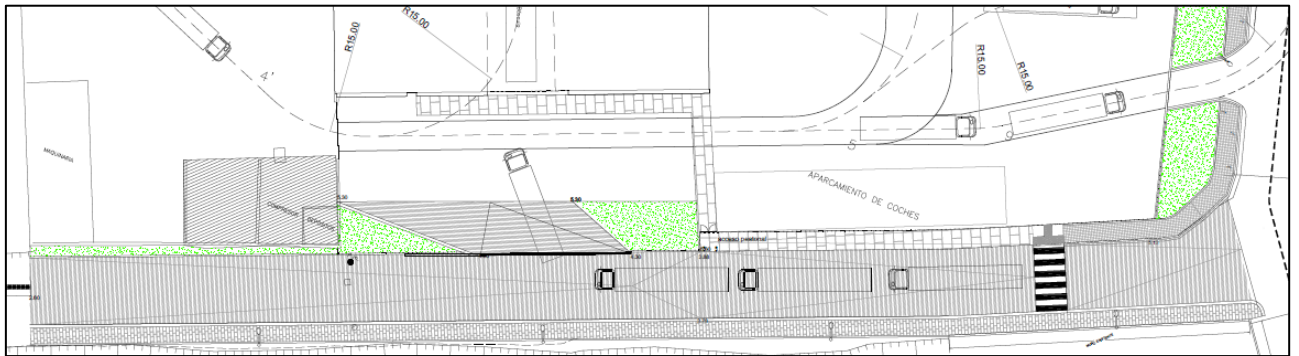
Planta sur de la parcela. Vial paralelo a la ría Asua.
